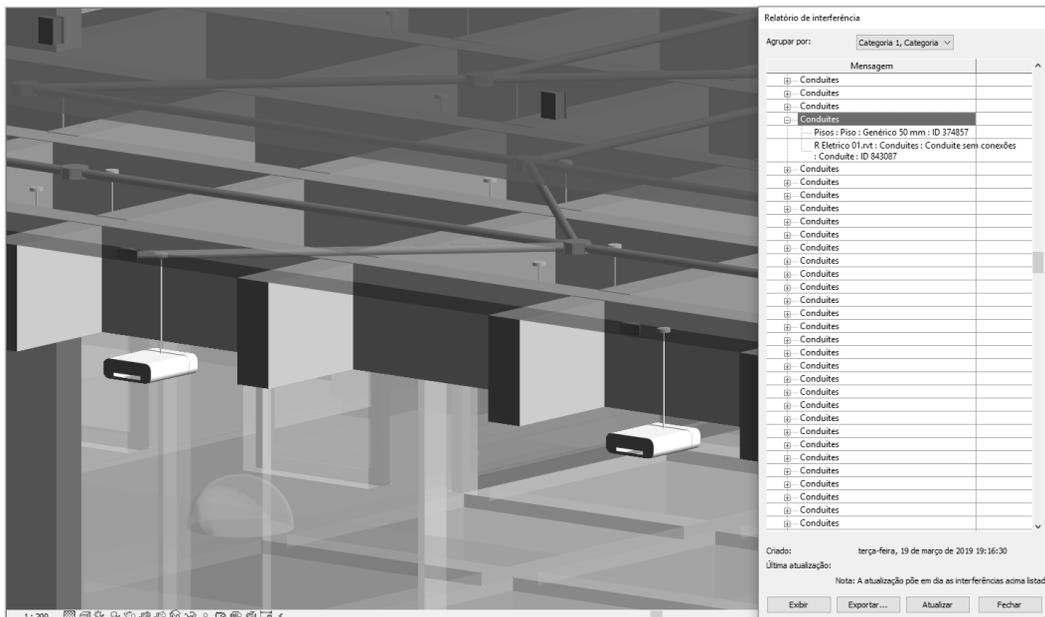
Conduíte em sobreposição com a laje. Fonte: desenvolvido pelo autor
